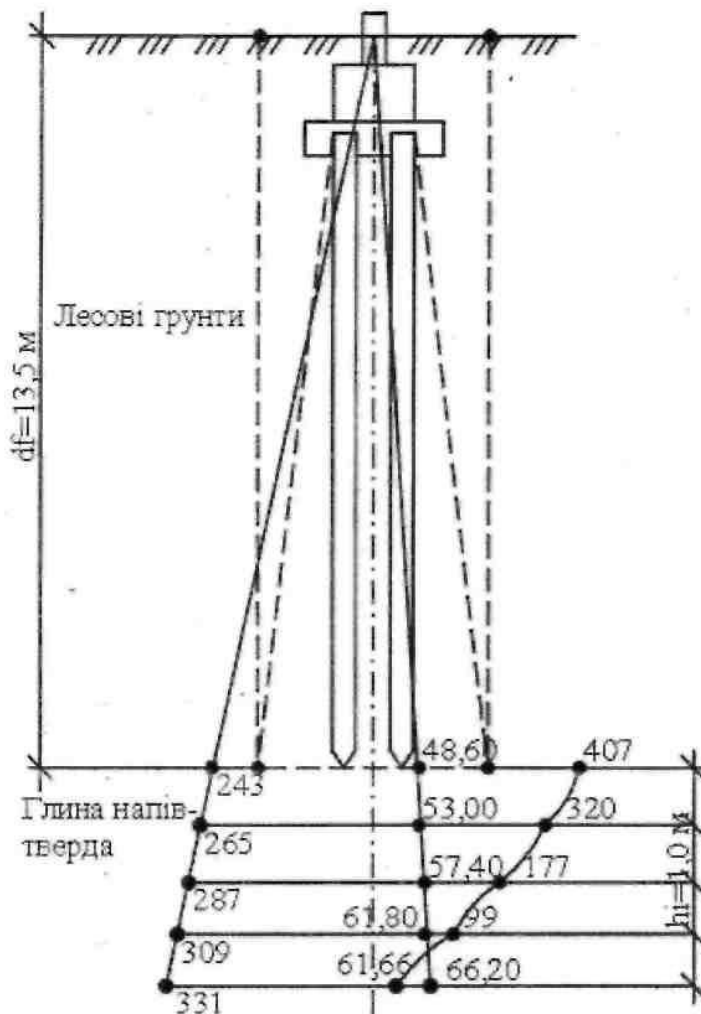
Розподіл вертикальних напружень з лінійно - деформативному напівпросторі під подошвою фундаменту.
